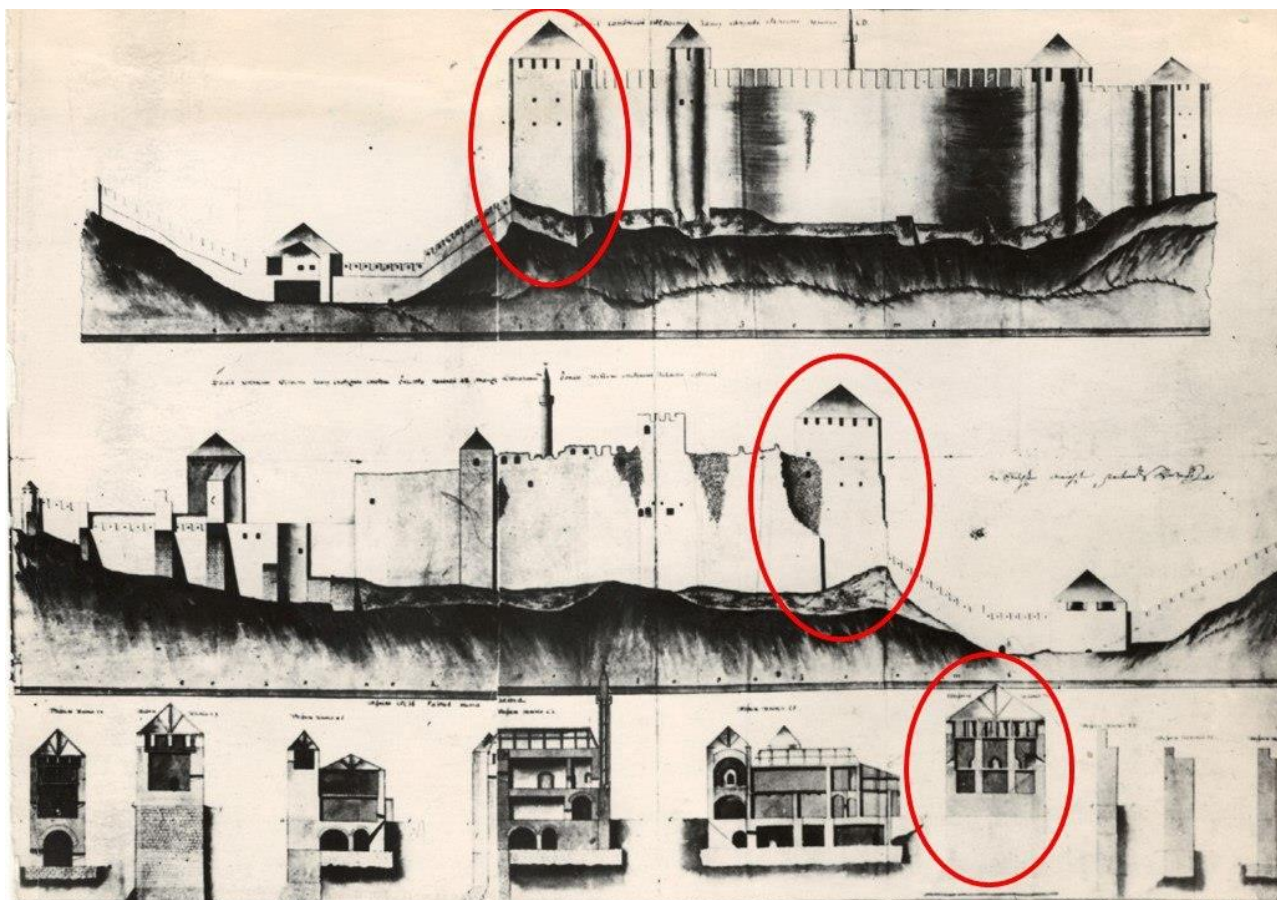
Північна башта на зображенні «Фасады и разрезы стен и зданий 1769 г.».
